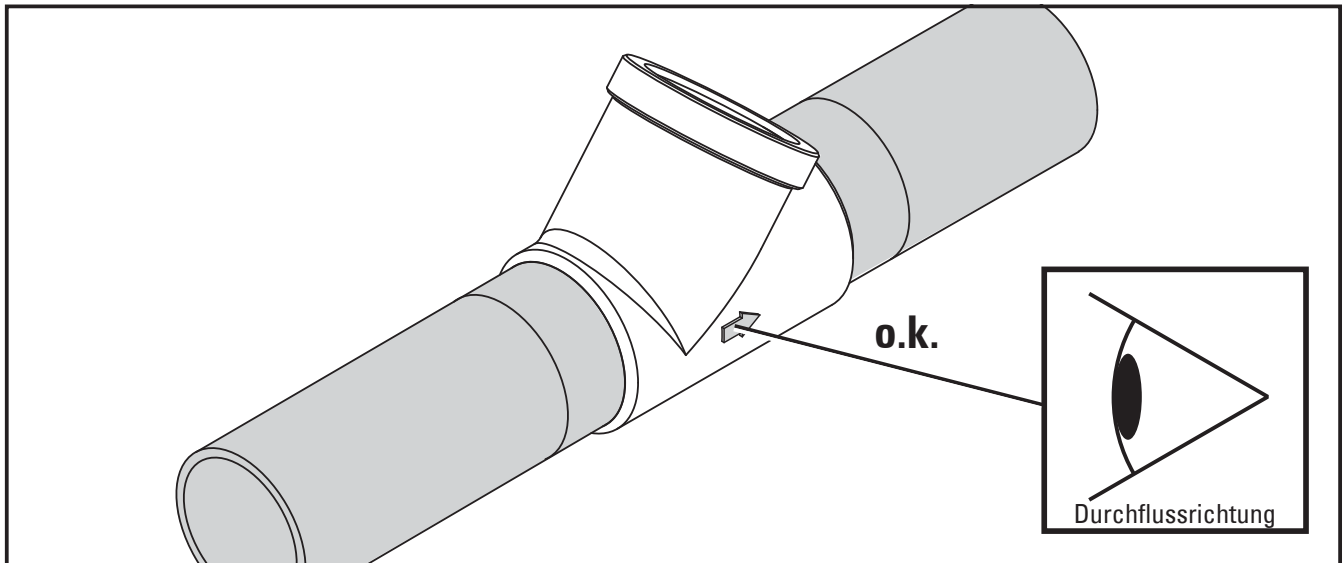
Anschweißen des Ventilgehäuses
